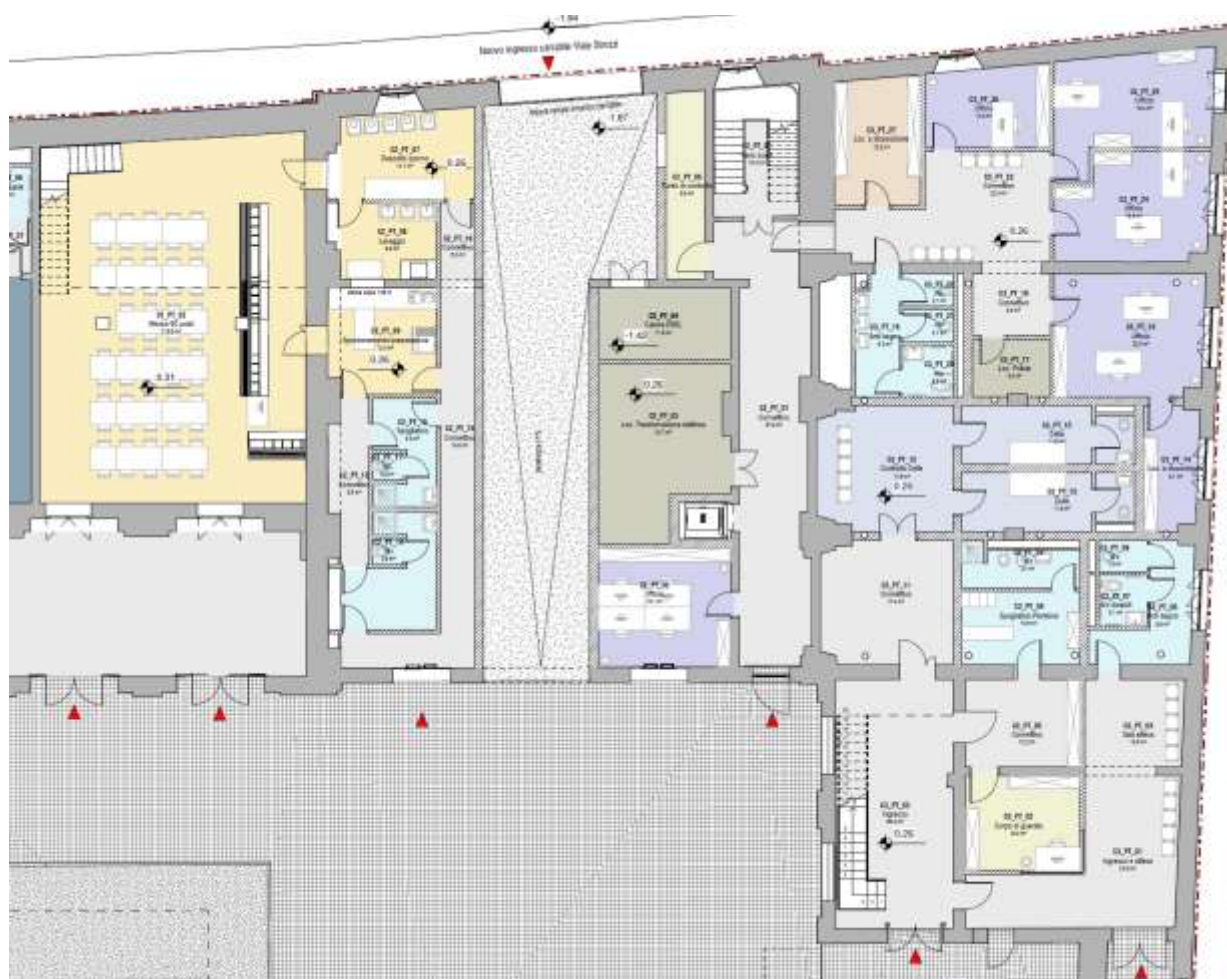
Edificio C2, pianta piano terra – estratto della pianta con le indicazioni funzionali
